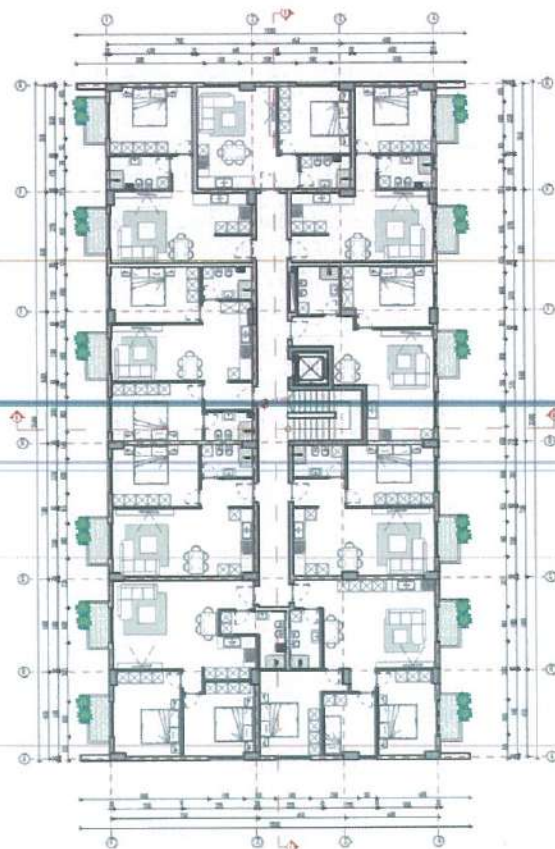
Planimetria e katit të parë, tretë & pestë, objekti 3 & 4
